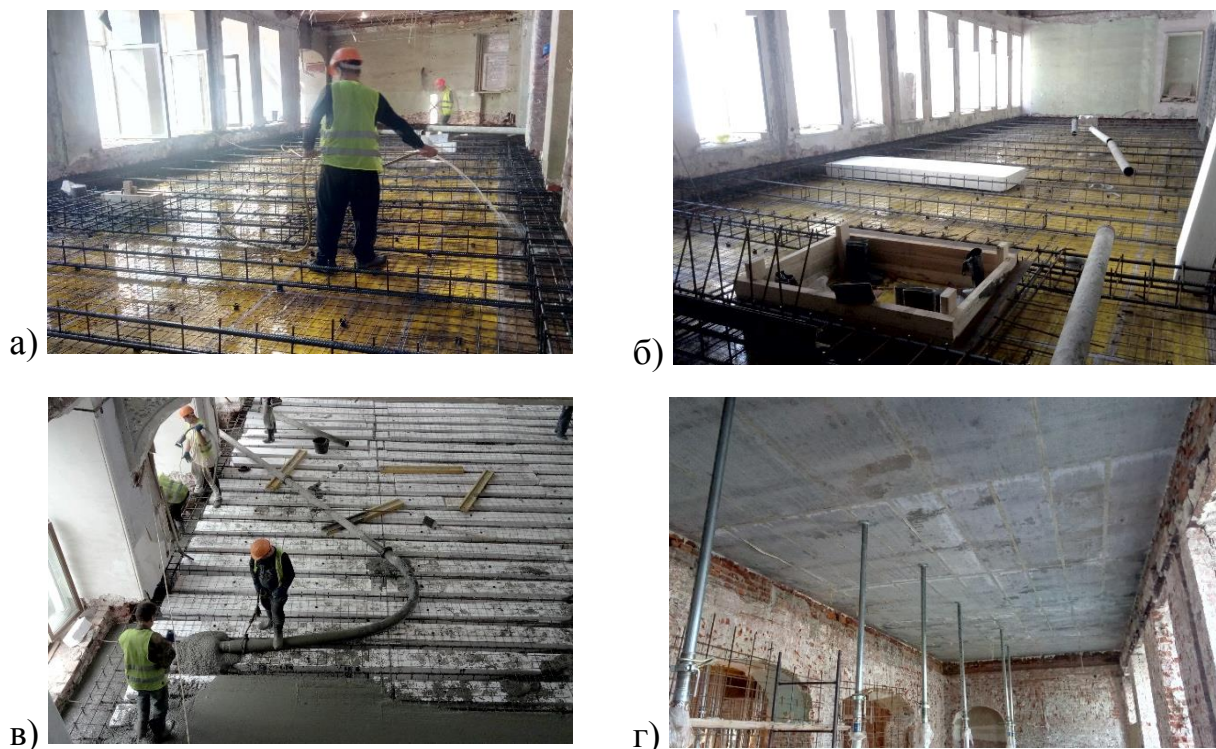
Влаштування полегшеного залізобетонного перекриття: а) укладання нижньої арматурної сітки і каркасів; б) установка вкладишів; в) укладання бетону перекриття; г) часткове розпалублювання перекриття
